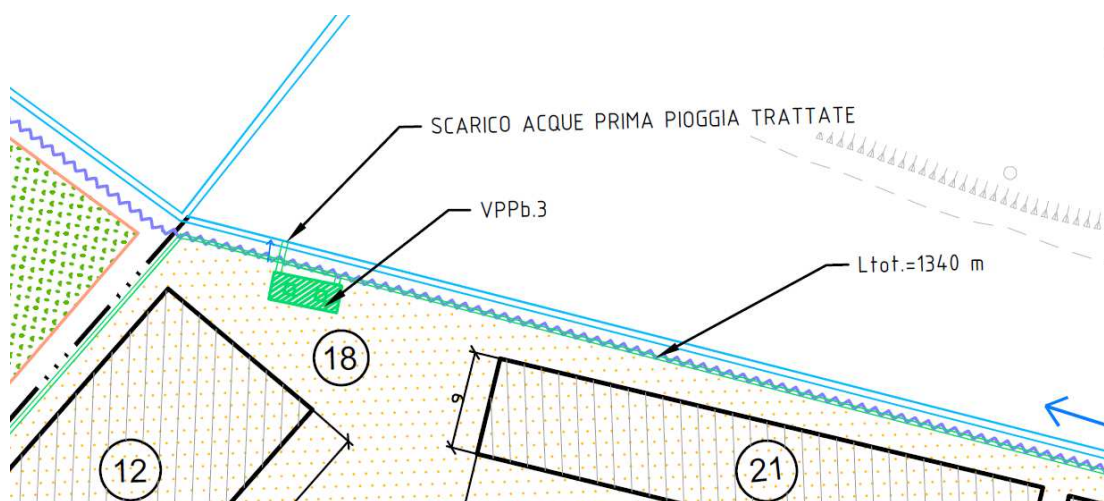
Stralcio planimetria aree di cantiere. In verde chiaro sistema di trattamento acque prima pioggia provenienti dal cantiere
